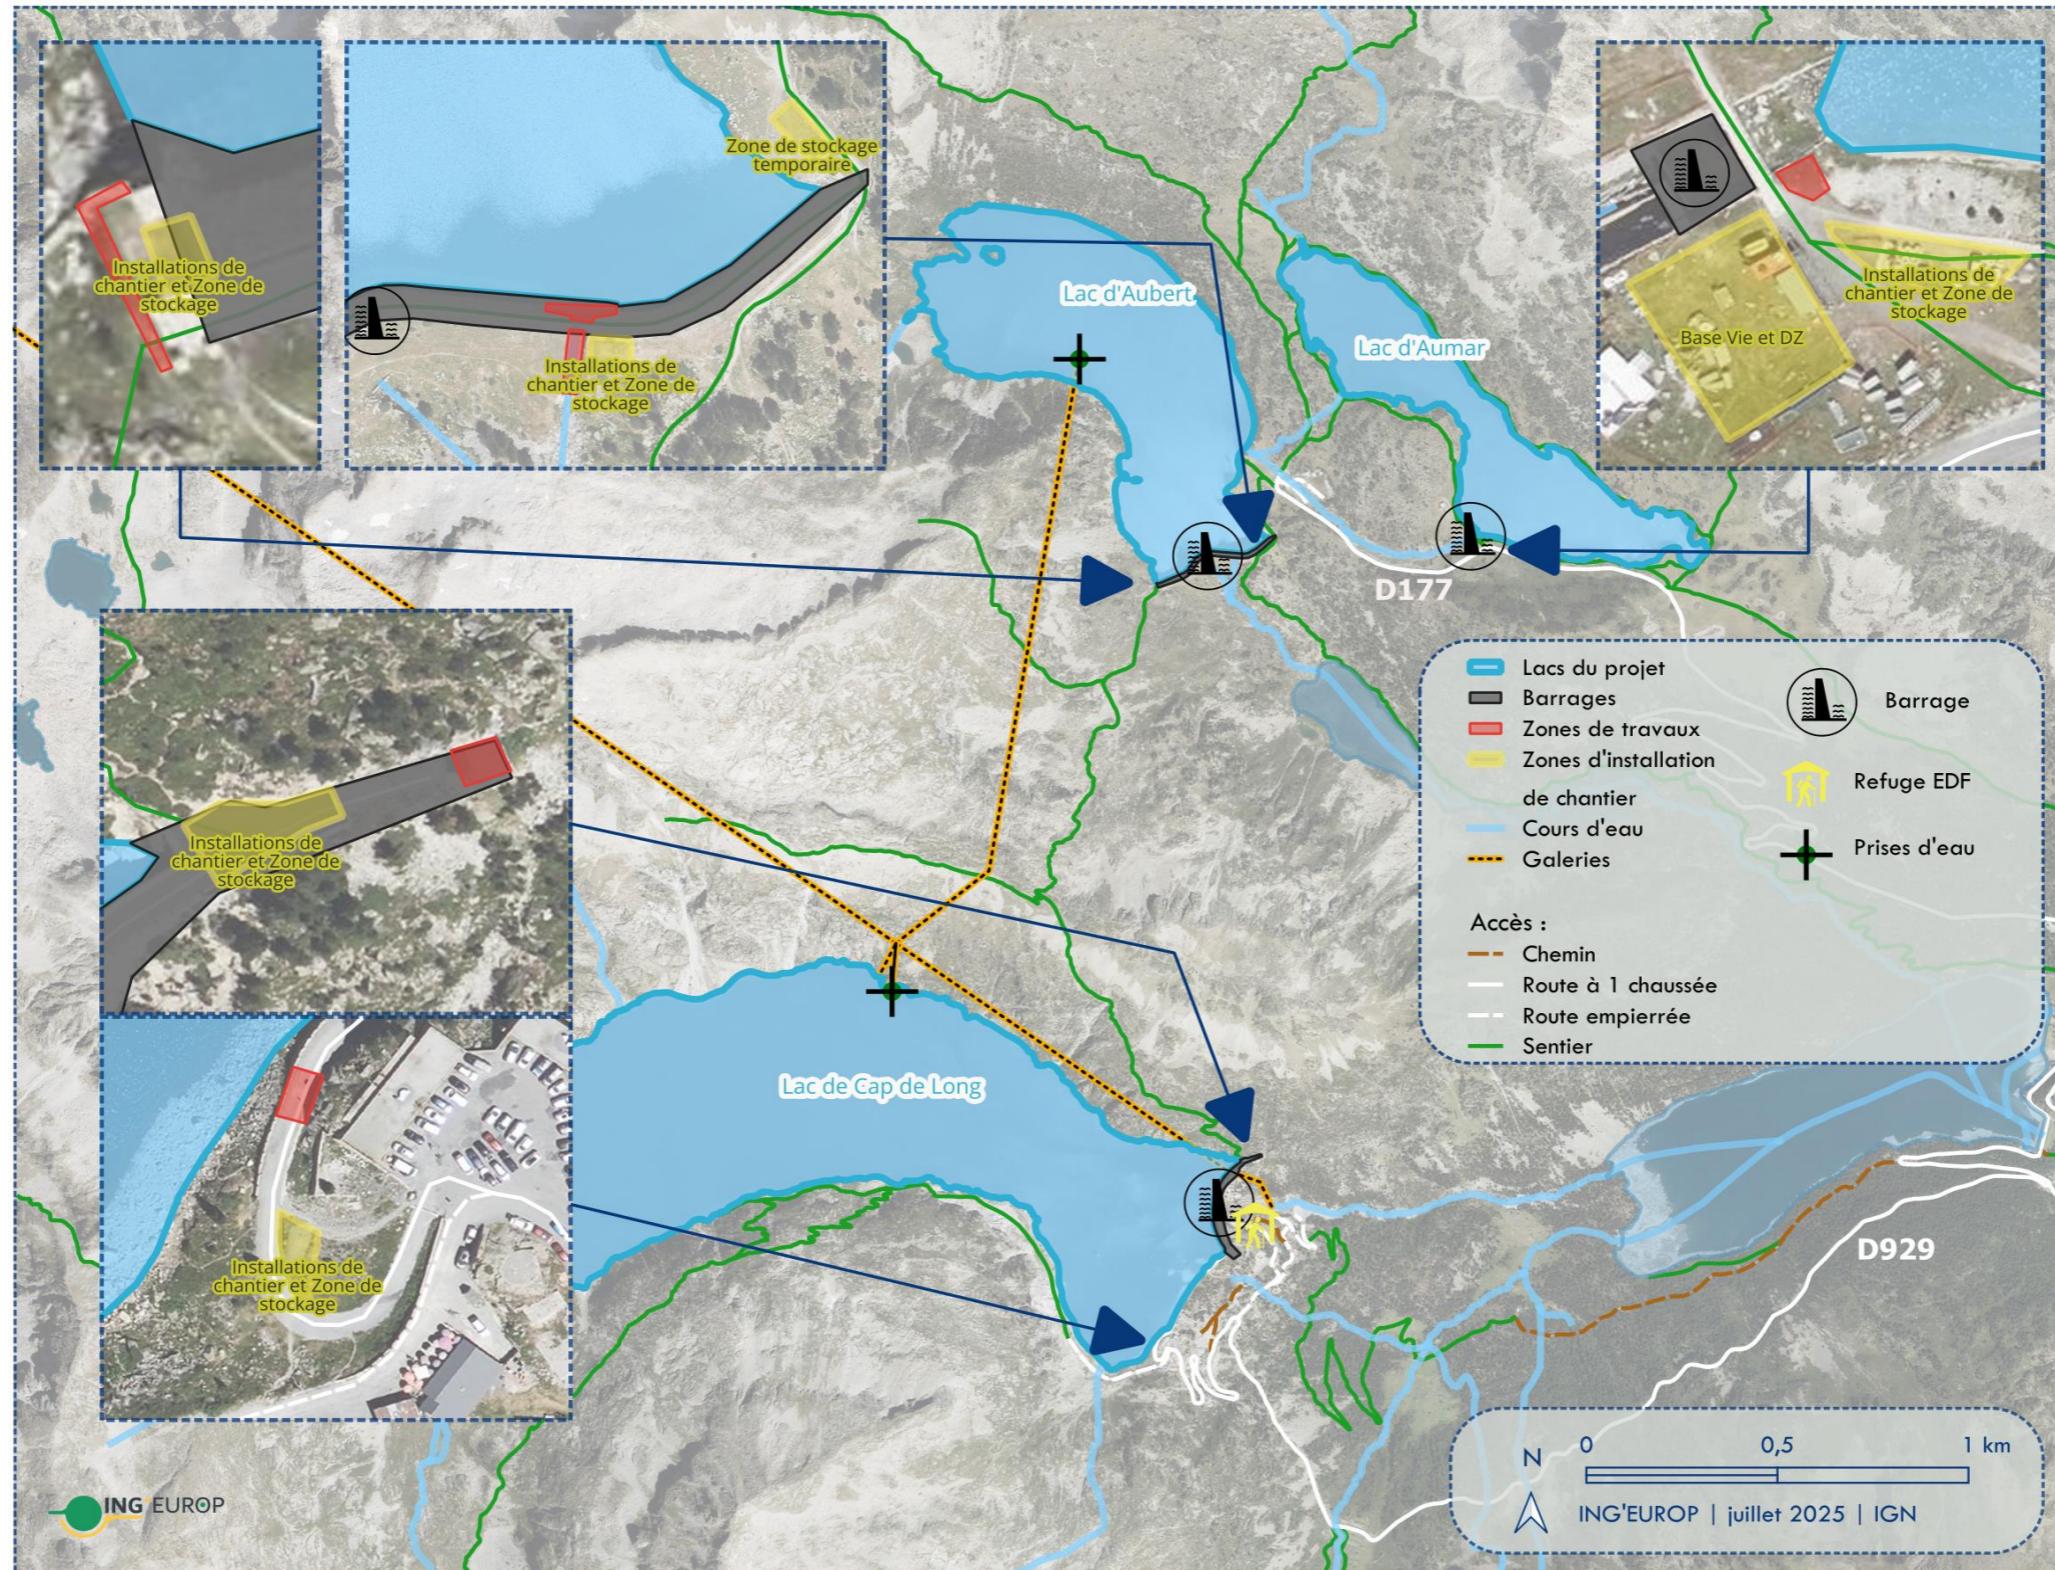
Localisation des accès et installations de chantier liés aux travaux sur les trois barrages
